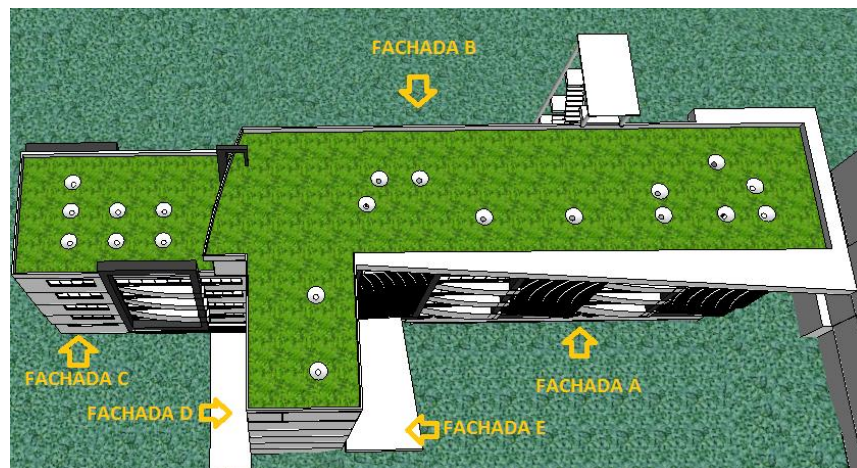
Fachadas del Edificio de Ingeniería Eléctrica.
